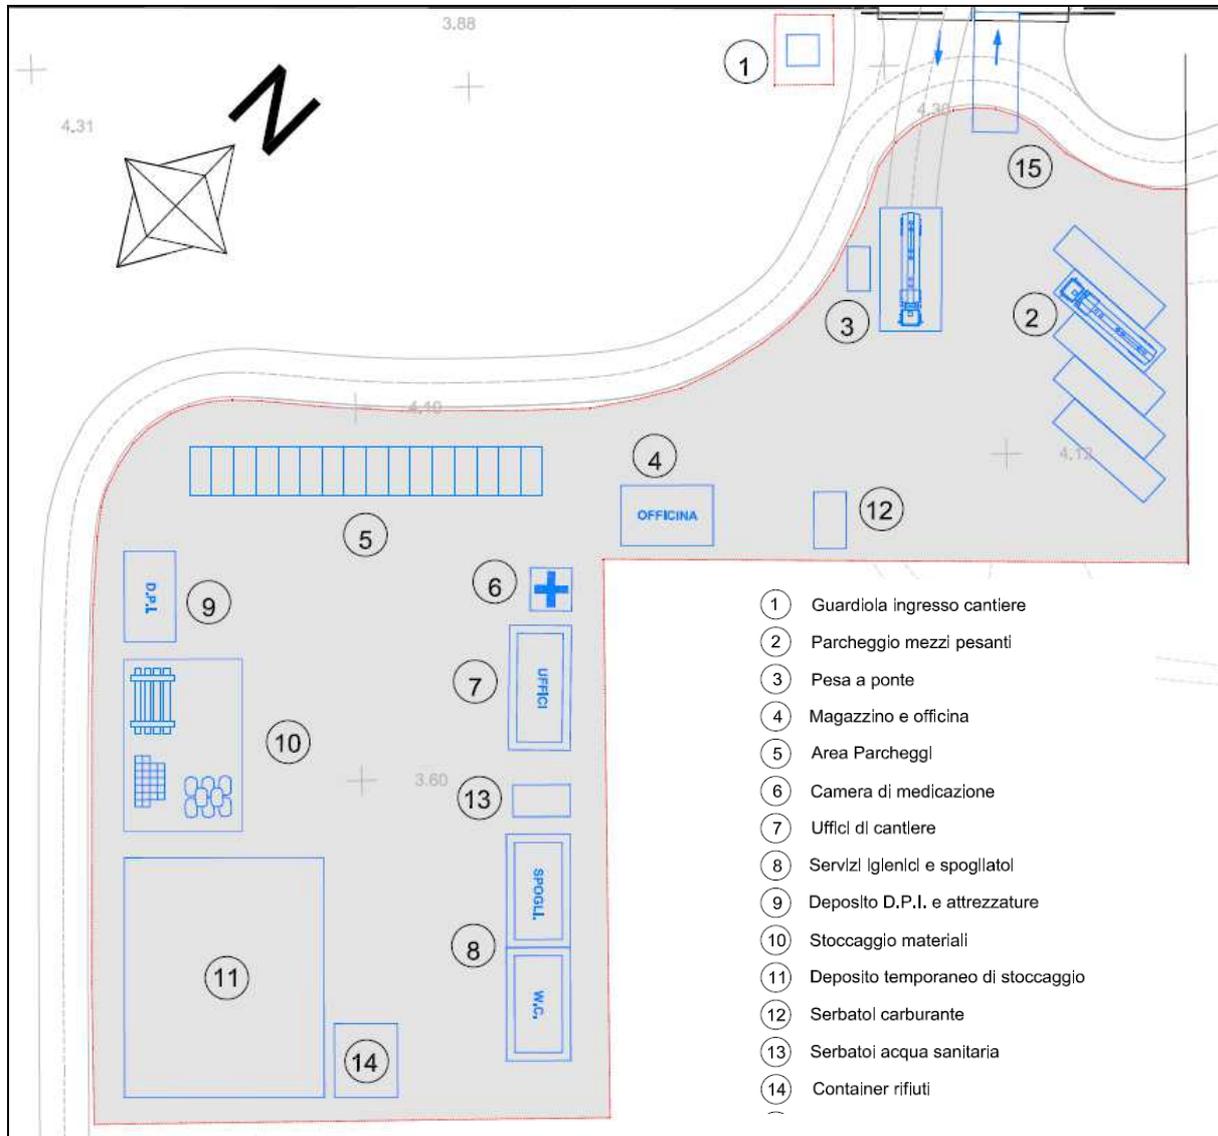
Area di cantiere e suddivisione delle aree logistiche
